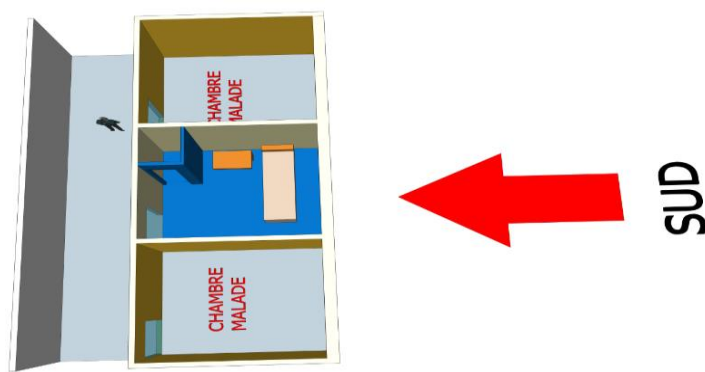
Plan R+2 présente la chambre d'hospitalisation
